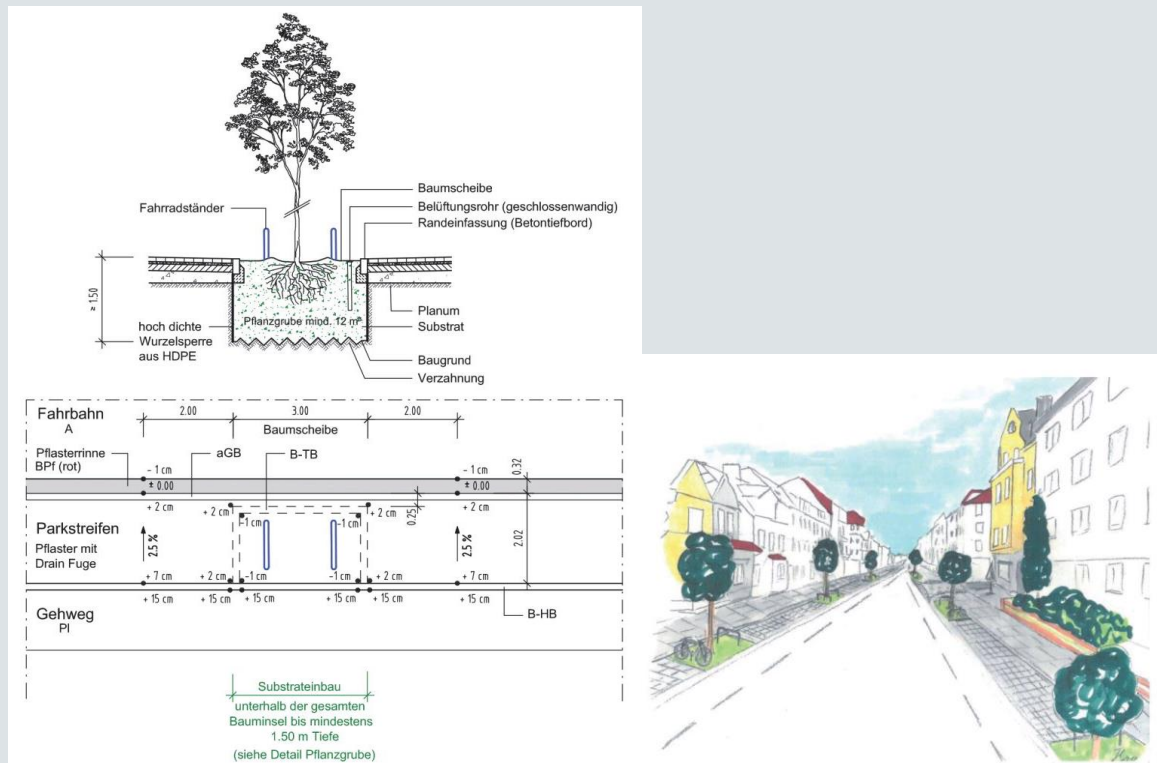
Detailplanung der Baumscheibe an der Münchener Straße in Bremen (Quelle: Stadt Bremen 2014).
